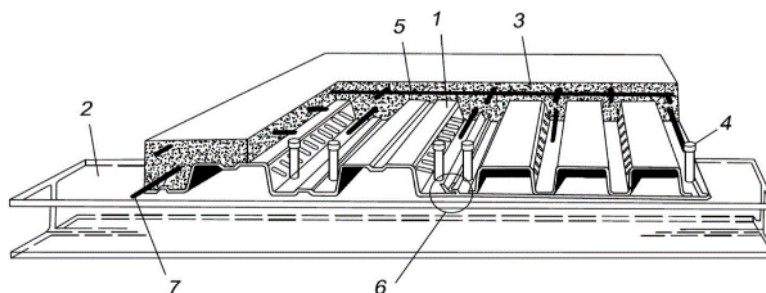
Сталежелезобетонная плита, армированная профилированным настилом
